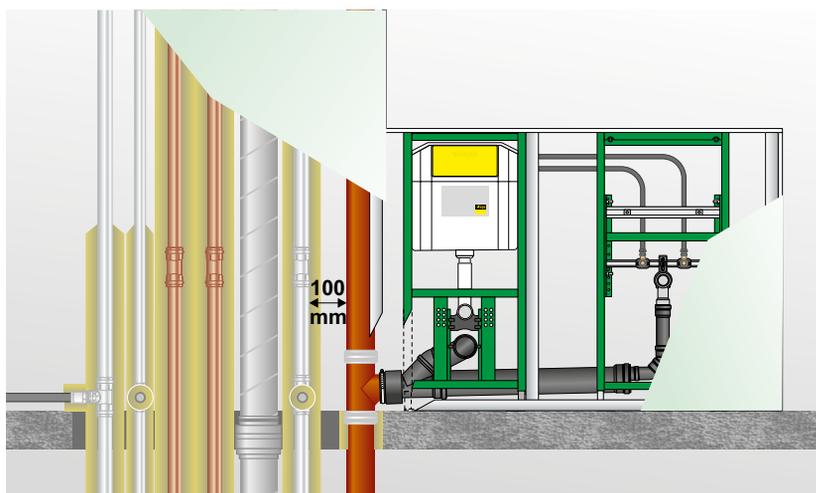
Wirtschaftlicher Schachtaufbau mit Guss SML Falleitung
